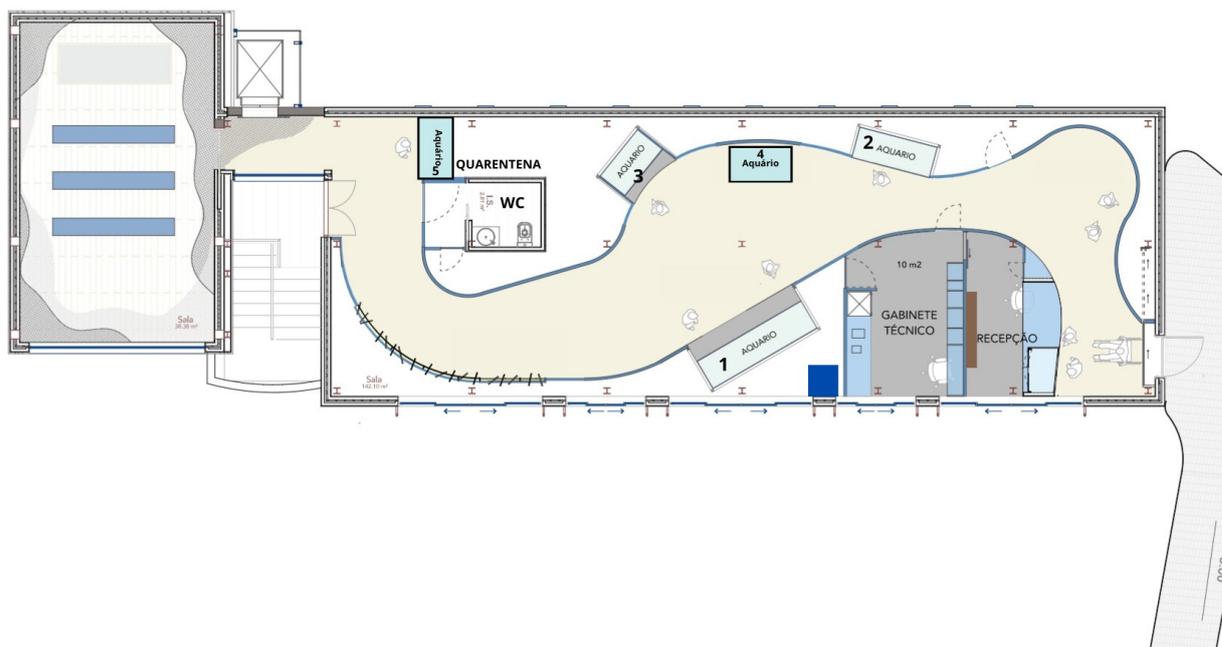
Estudo prévio: Layout do projeto para o C-Life (planta do espaço)
